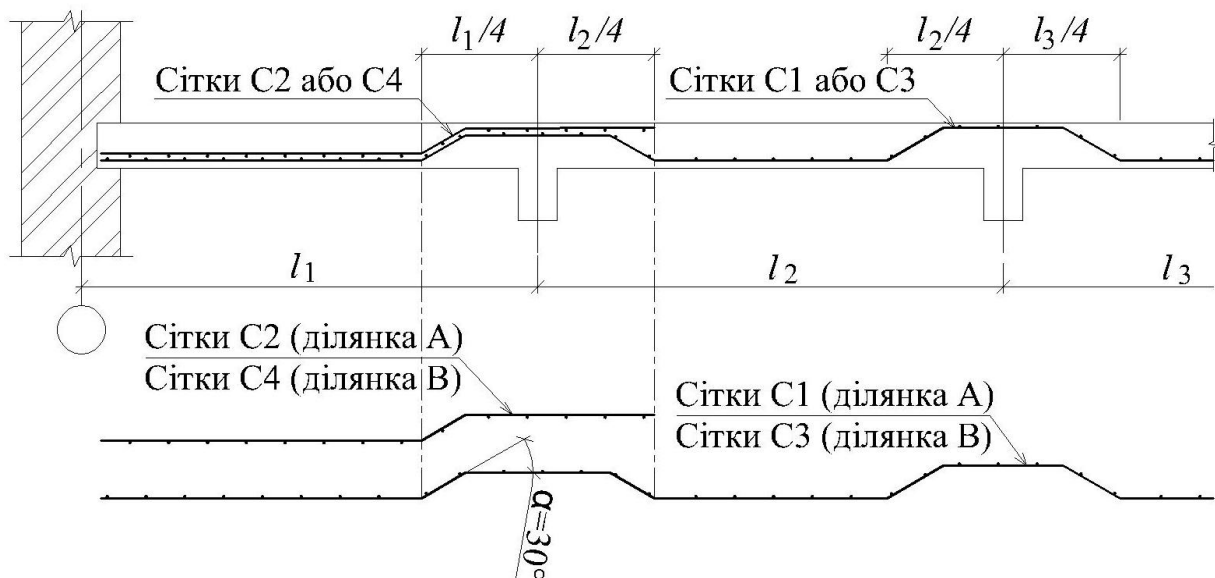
Армуння плити рулонними зварними сітками з поздовжньою робочою арматурою
